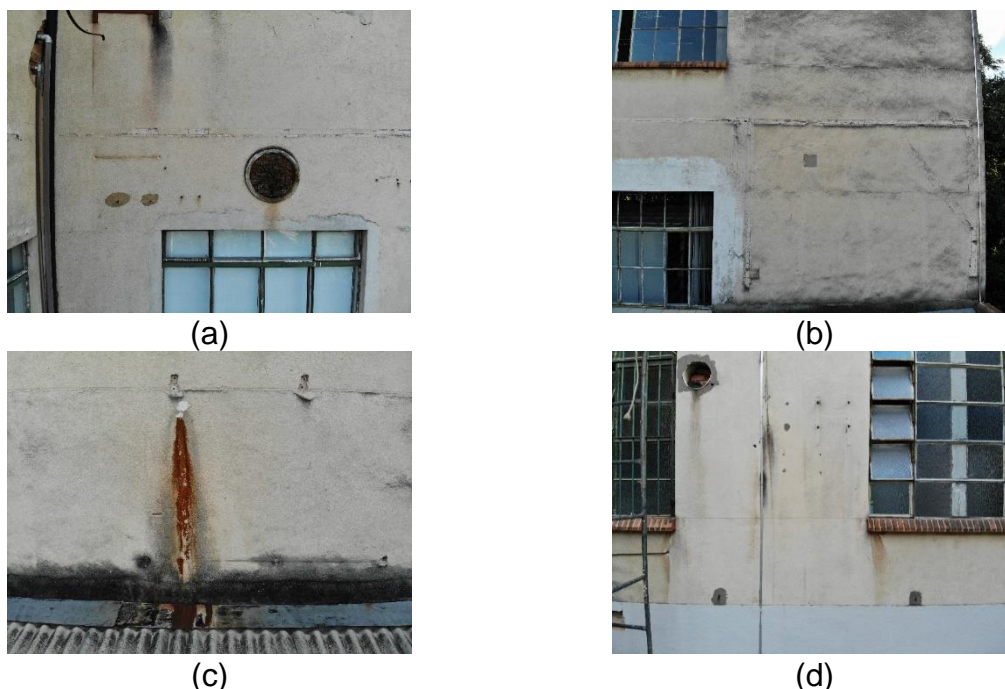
Danos provocados por instalações nas fachadas: (a) tubulações e exaustor; (b) instalações embutidas com reparos mal executados; (c) corrosão de elemento metálico instalado na fachada; (d) exaustor e furações antigas não tampadas.
